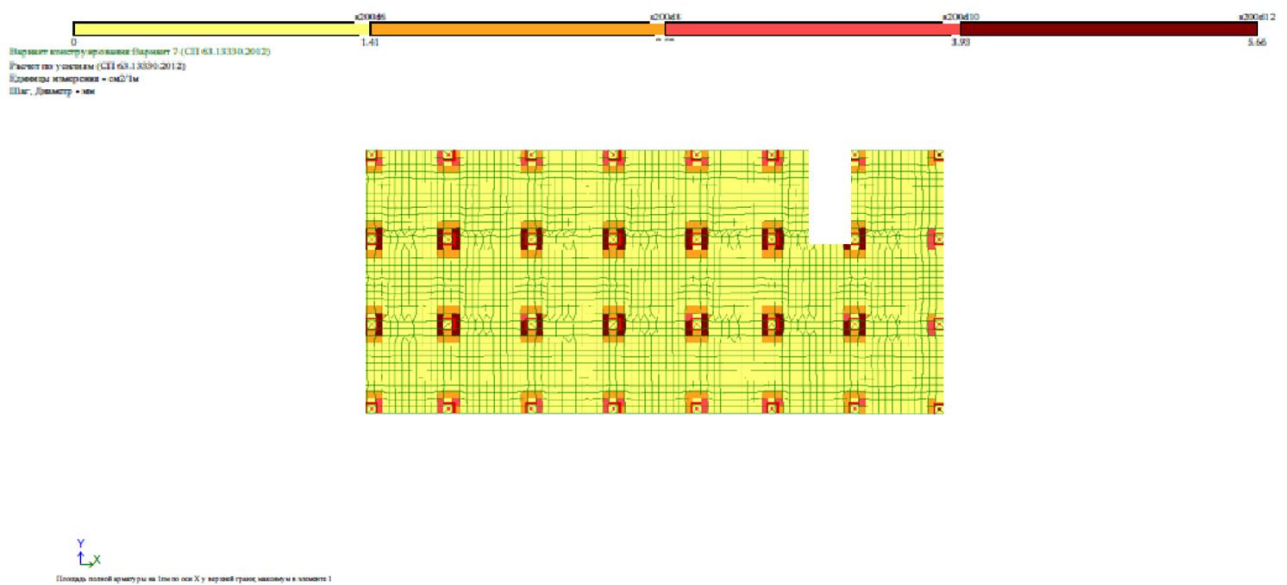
Подбор верхней продольной арматуры плиты
